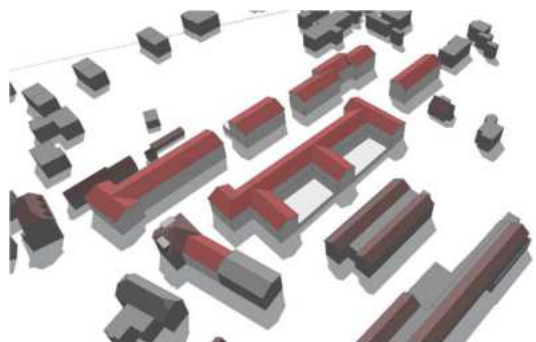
Baumassenstudie Ansicht Nord-Ost Neu
